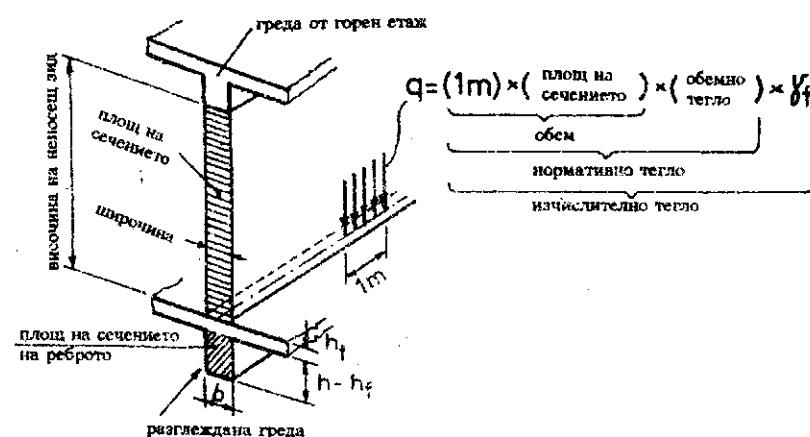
Натоварване от прилежащи площи и други греди.
